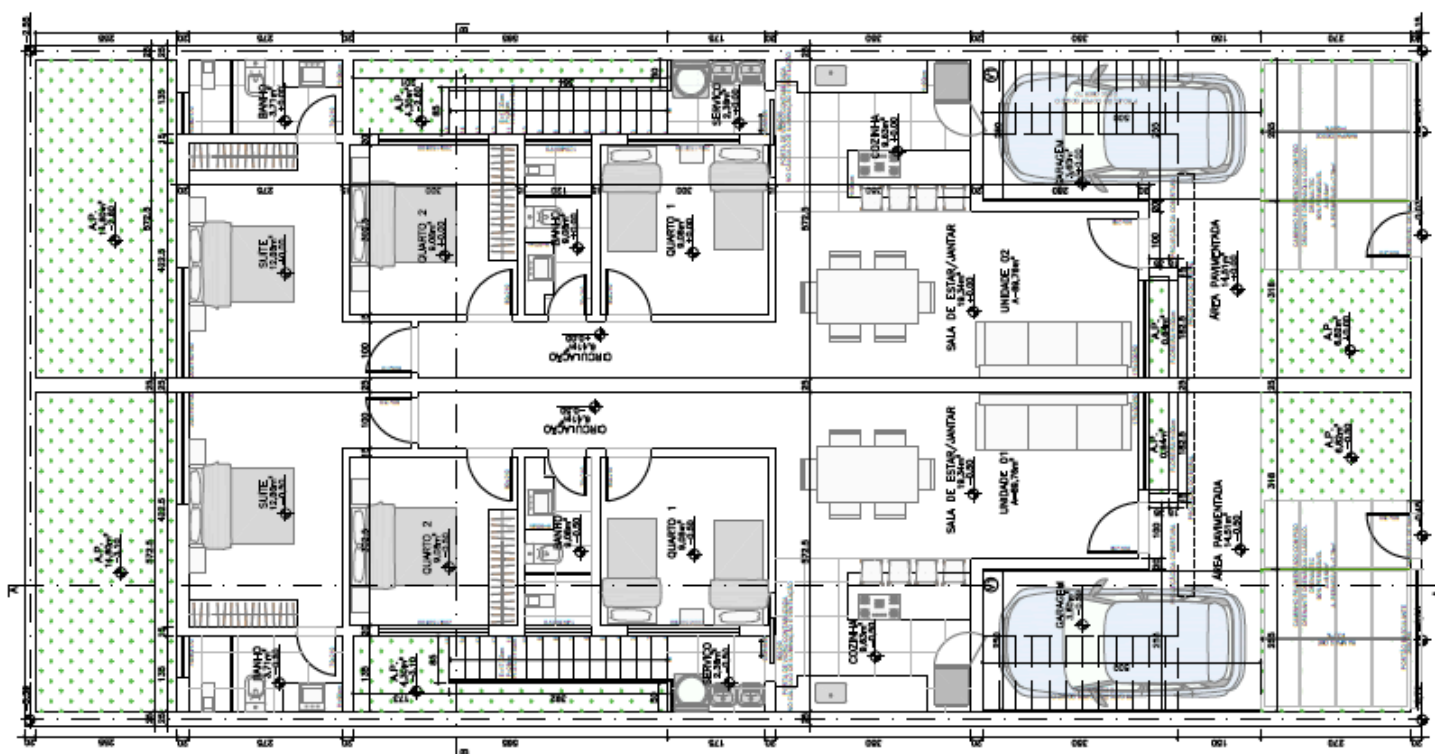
Planta baixa e implantação da edificação. Fonte: Luana Bastos Arquitetura
